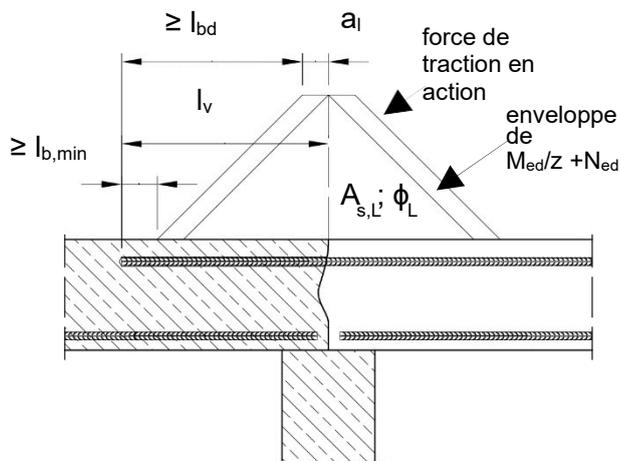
recouvrement d'armatures pour la liaison de dalles et de poutres
